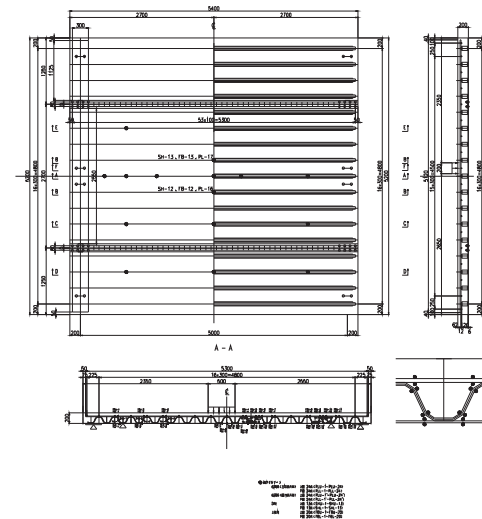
鋼ひずみゲージ取付位置 (底鋼板, ずれ止め) (単位: mm)
